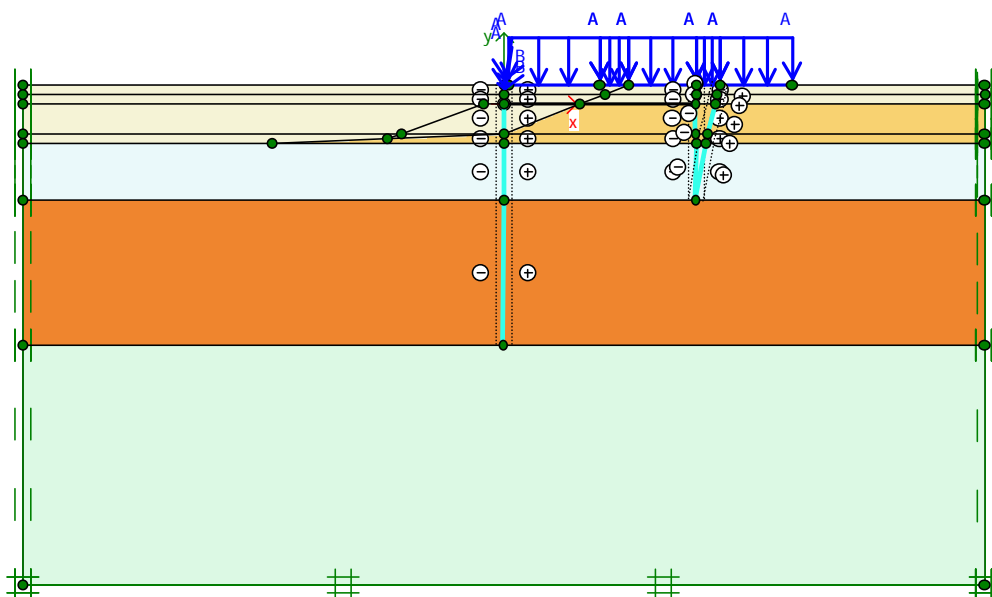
Sezione di calcolo A-A spalla sinistra con Plaxis
